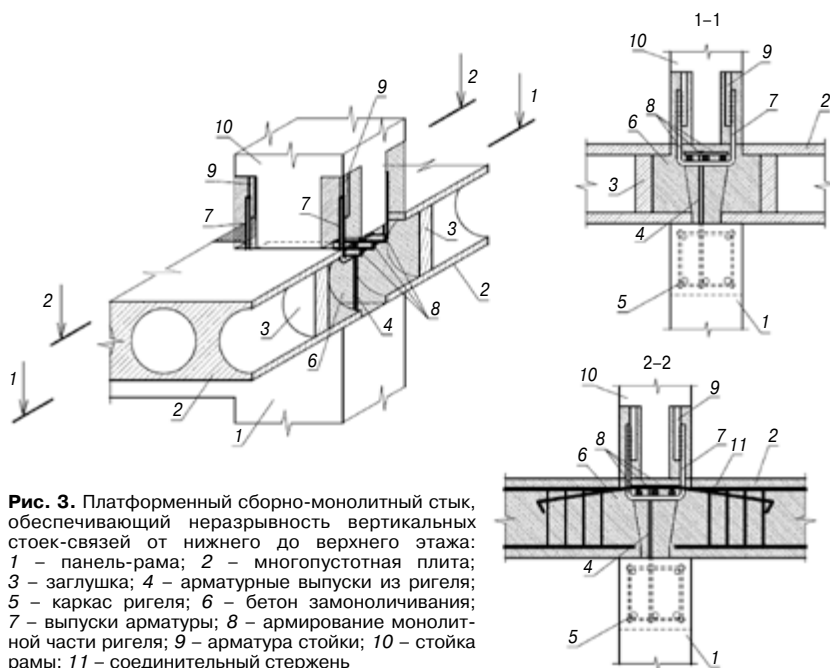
Платформенный сборно-монолитный стык, обеспечивающий неразрывность вертикальных стоек-связей от нижнего до верхнего этажа: 1 – панель-рама; 2 – многоячеечная плита; 3 – заглушка; 4 – арматурные выпуски из ригеля; 5 – каркас ригеля; 6 – бетон замоноличивания; 7 – выпуски арматуры; 8 – армирование монолитной части ригеля; 9 – арматура стойки; 10 – стойка рамы; 11 – соединительный стержень
